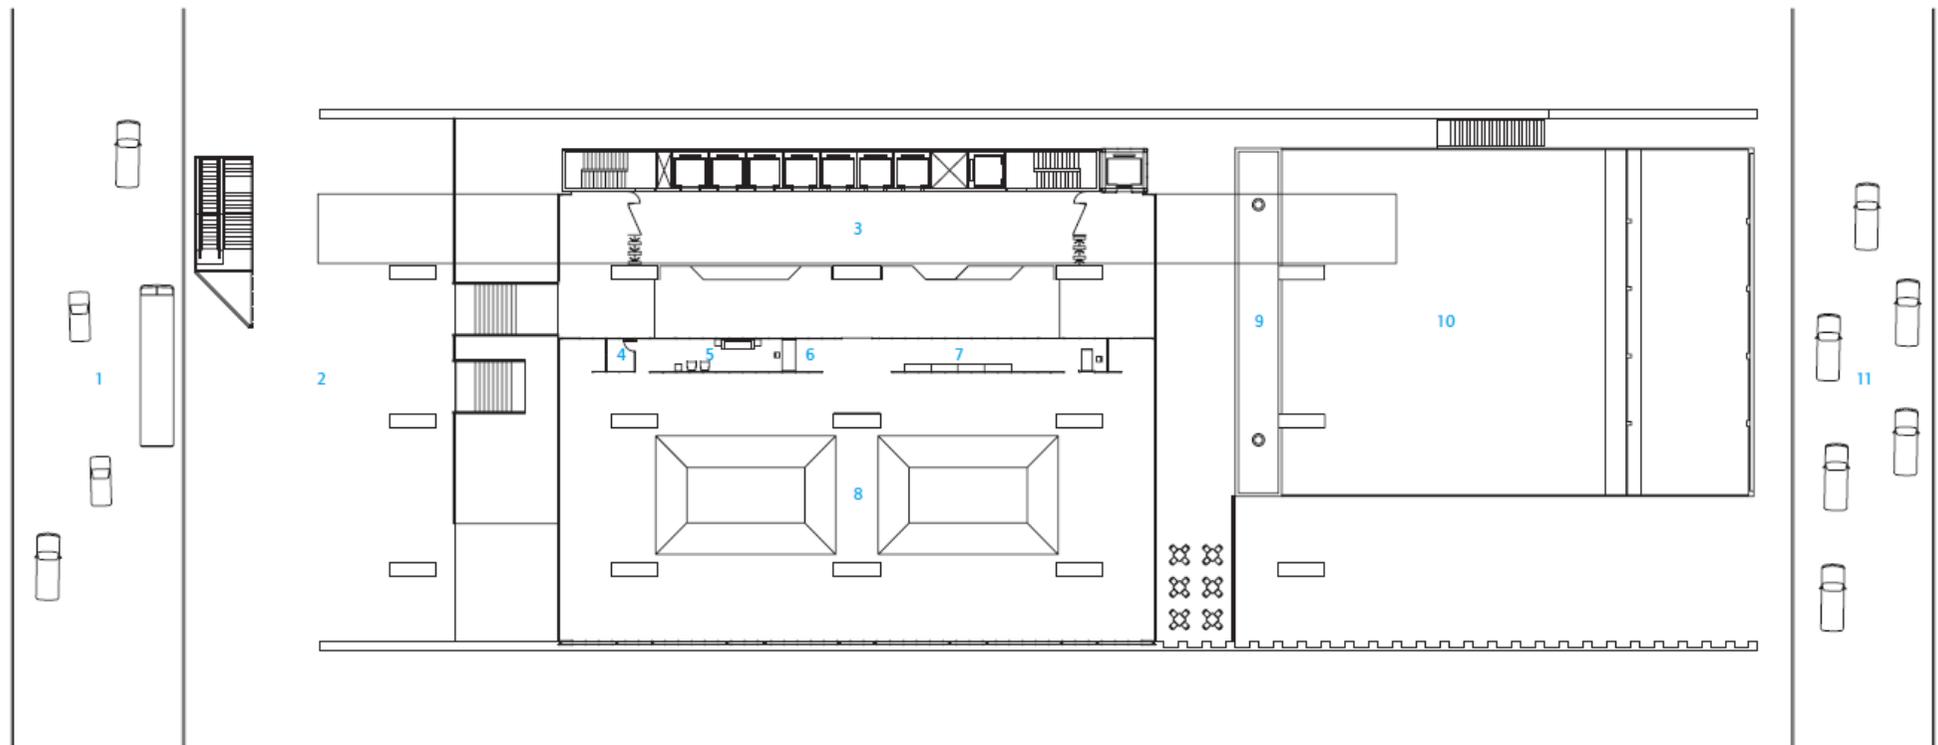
Pavimento térreo superior – corredor de acesso ao pavimento
